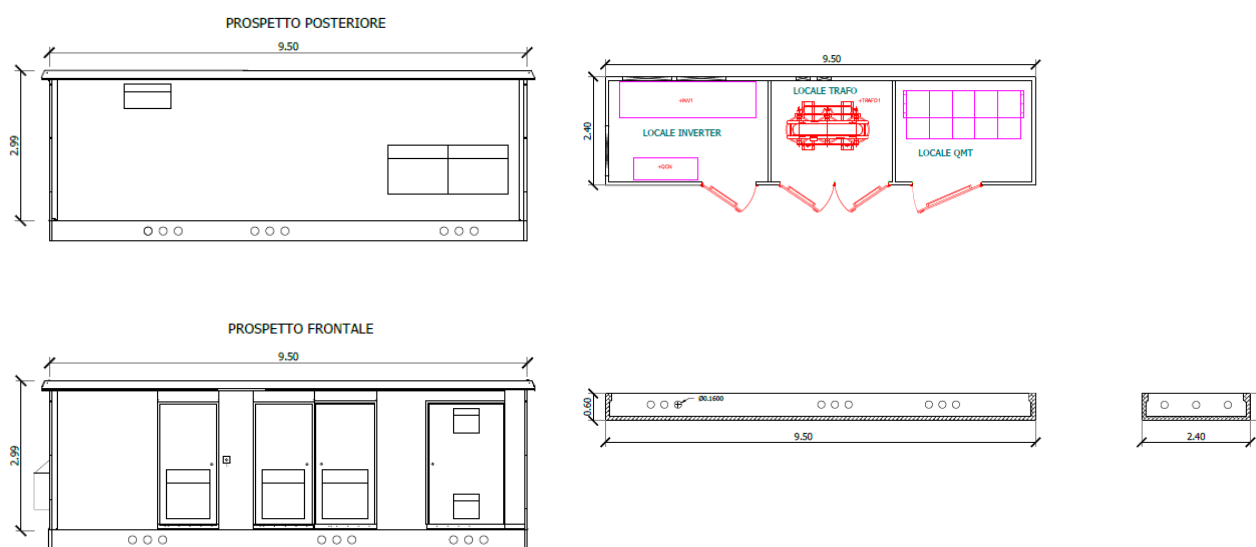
pianta e prospetto cabine di conversione e trasformazione
